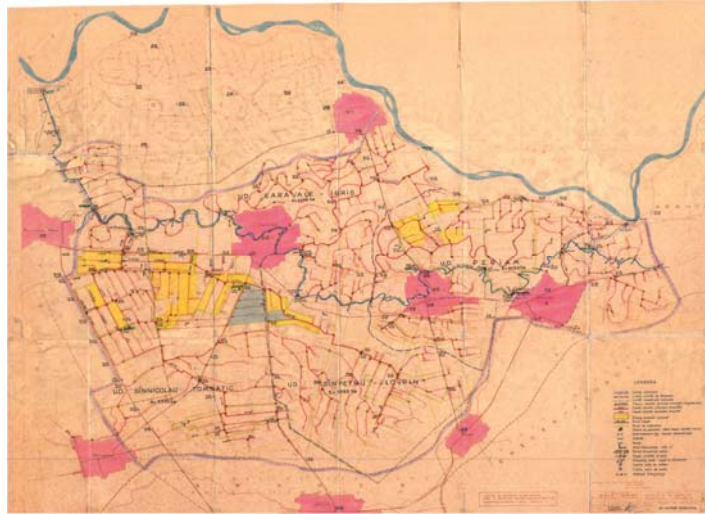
Plan de încadrare și plan de situație - Amenajarea Sânnicolau - Saravale
